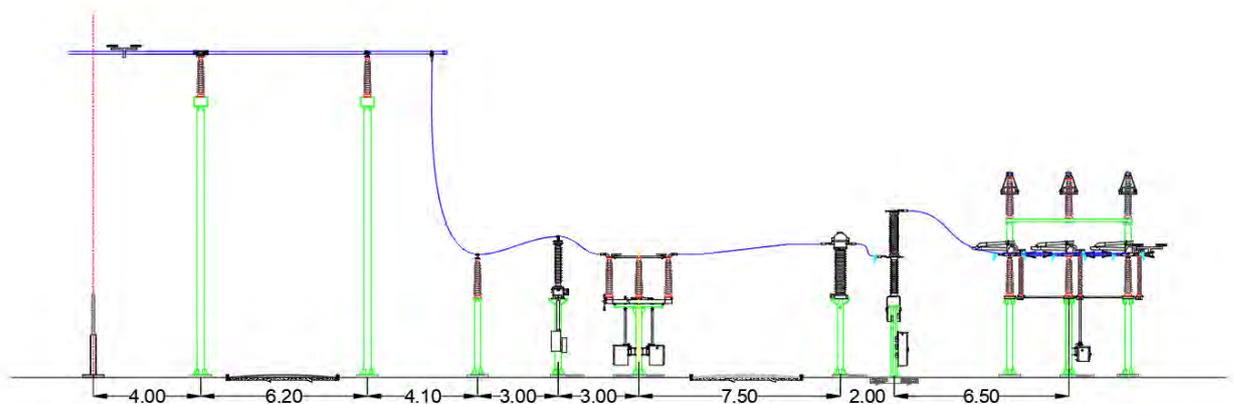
Sezione futuro stallo di arrivo in Stazione Elettrica RTN
